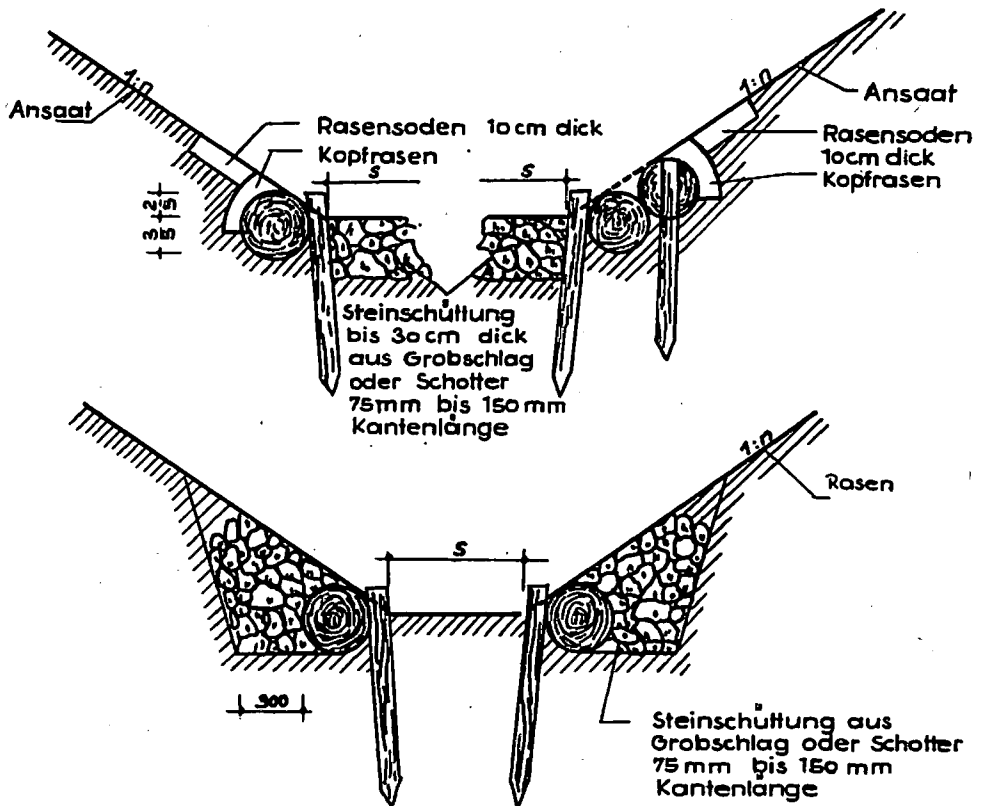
Kombinierte Befestigung — Faschinen und Steinschüttung
